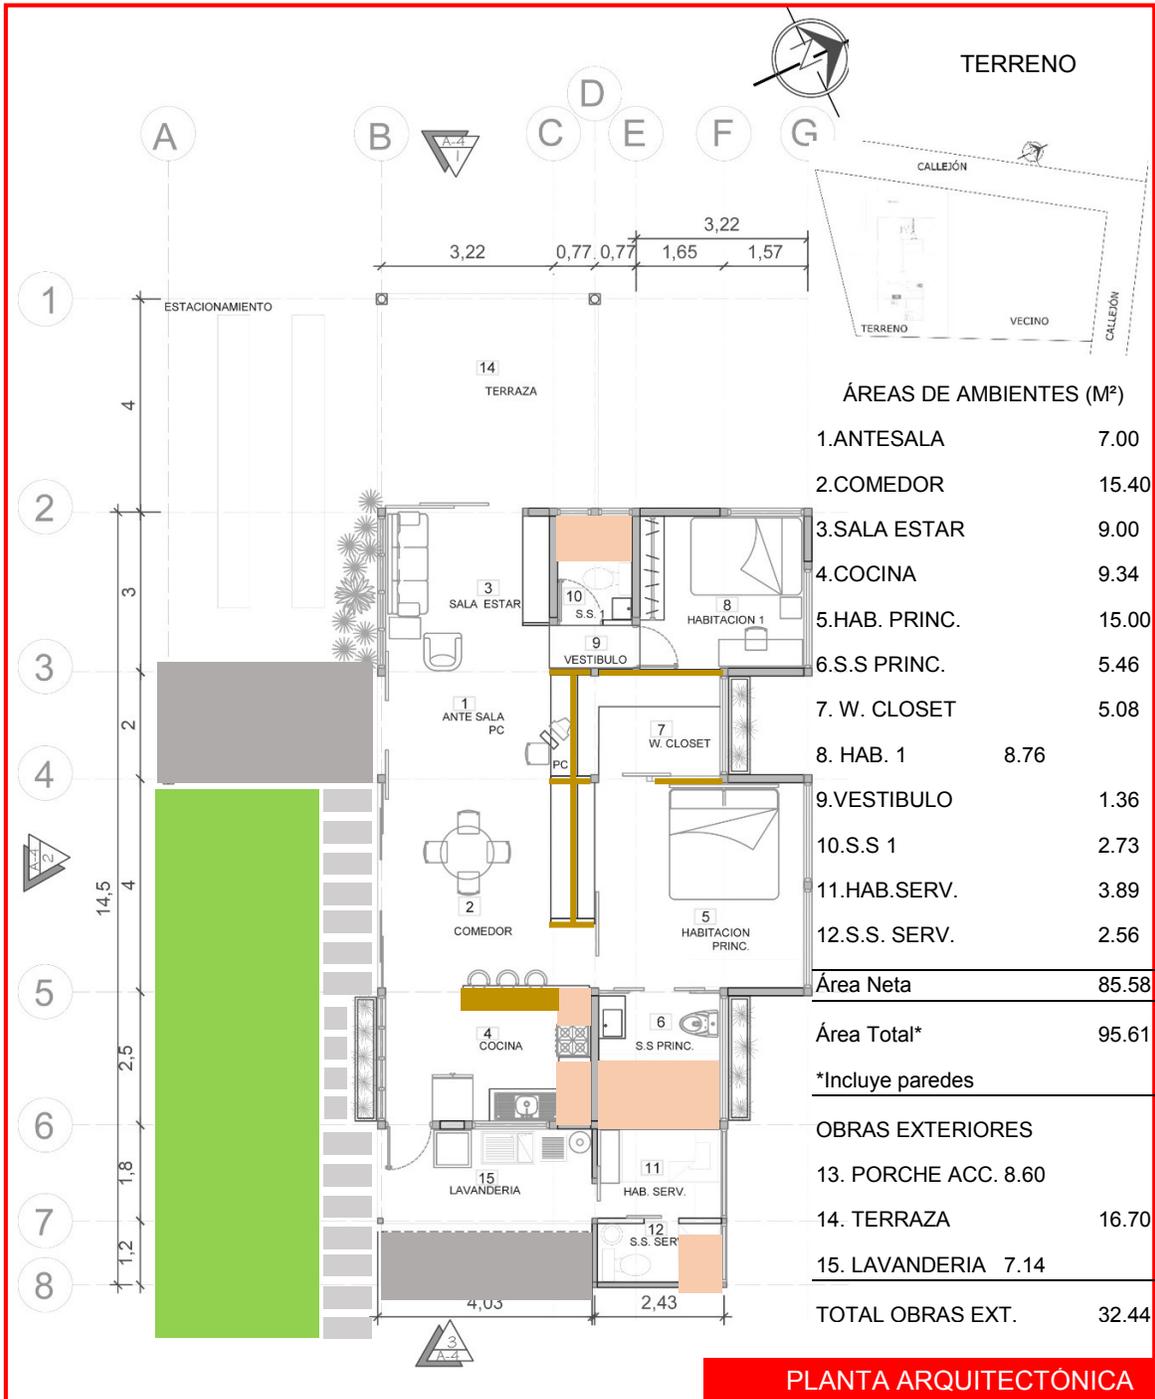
Planta Arquitectónica, Terreno & Áreas. Fuente: Autor. Programas: Autocad, Ilustrador.
